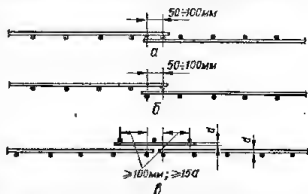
Стыки сварных сеток в направлении распределительной арматуры:
